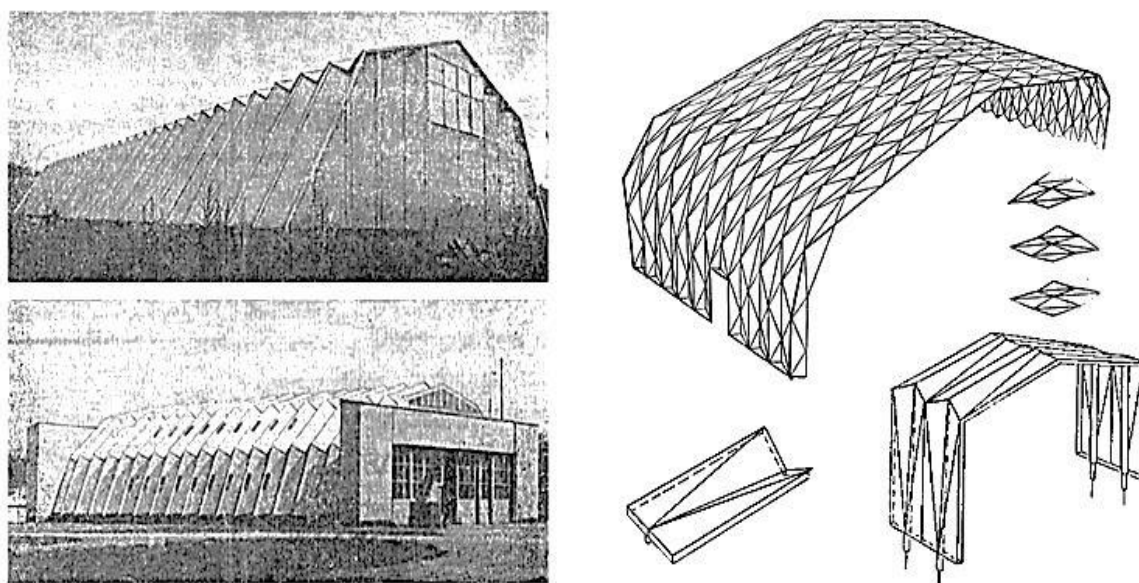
Первый патент на складчатое покрытие был выдан в 1937 г.
